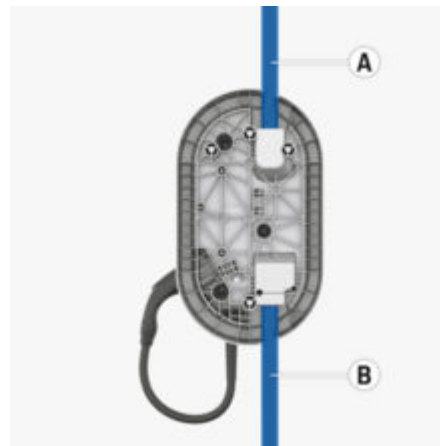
Accès aux câbles supérieurs et inférieurs (vue arrière du chargeur mural Wall Charger Connect, les conduits de câbles sont marqués en bleu)
